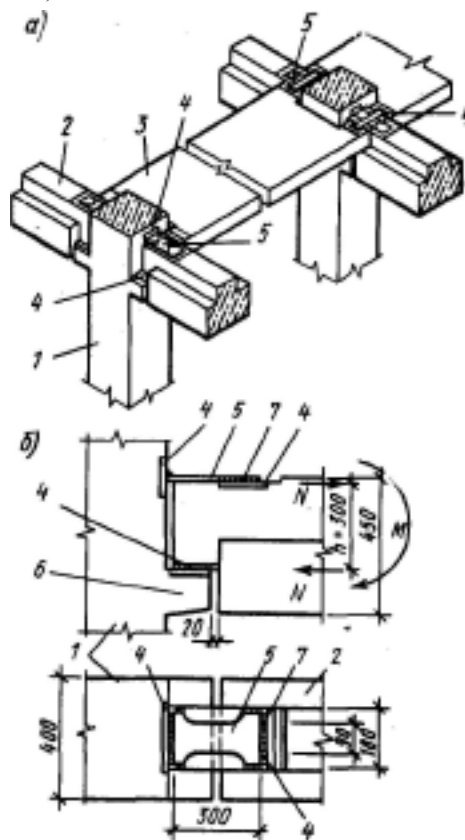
Узел опирания ригеля на колонну в унифицированном каркасе:
